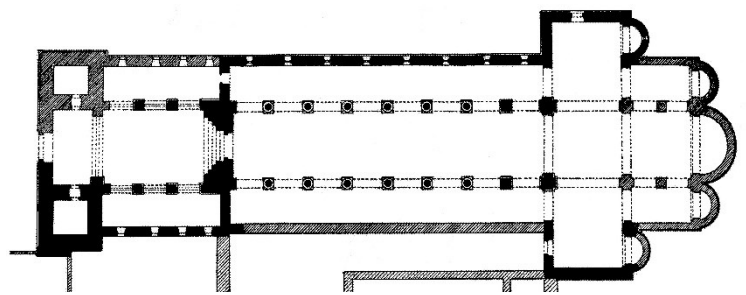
Grundriss der Klosterkirche Paulinzella
